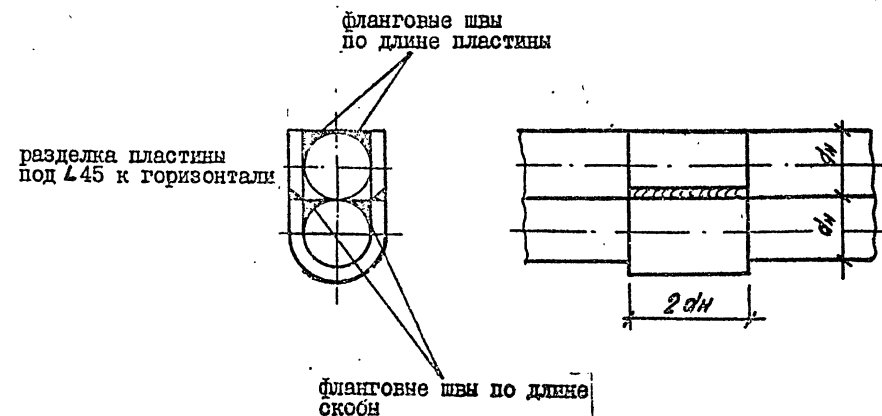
Конструкция сварного соединения спаренных стержней арматуры, выполненного одноэлектродной сваркой на стальных скобах.
